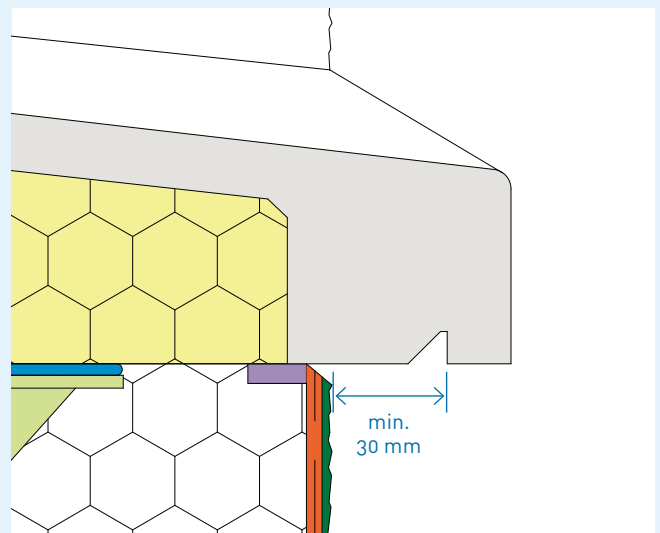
Fassadenüberstand bei Glasfaserbeton-Fensterbank
